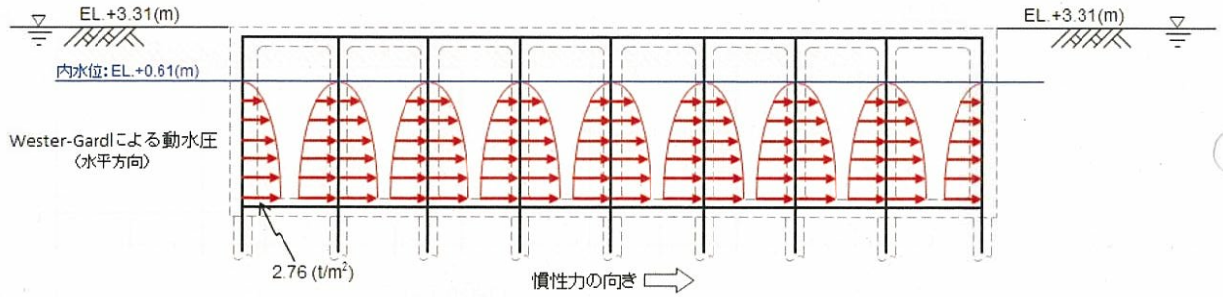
(1) 水平動による動水圧図 (①-①断面)
